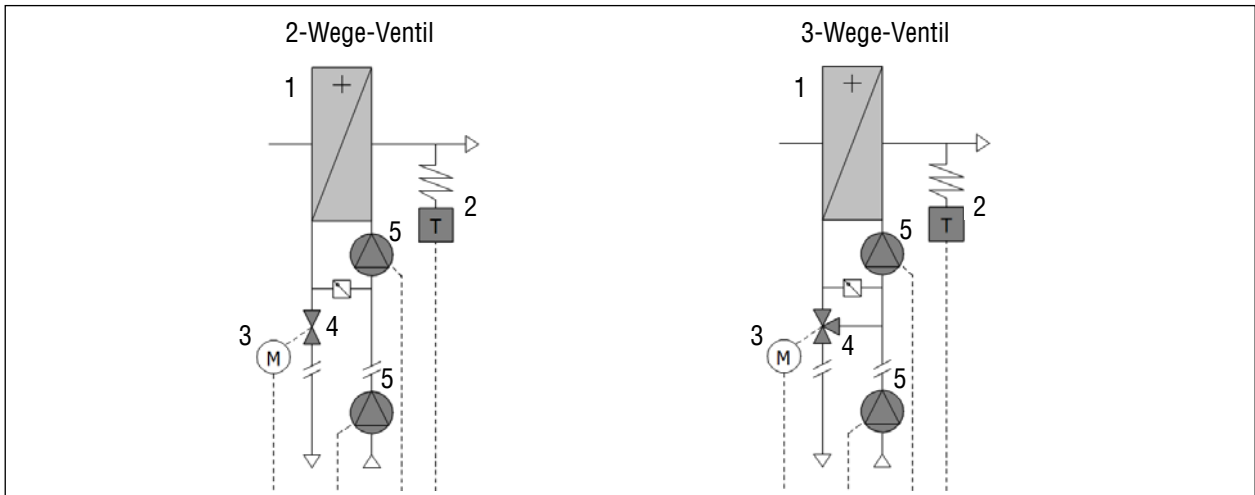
Anschlussausführungen mit 2-Wege-Ventil und 3-Wege-Ventil
